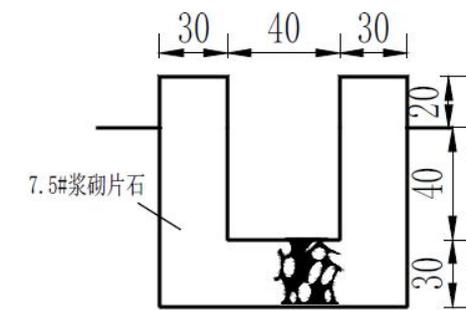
浆砌石排水沟典型断面图 (单位: cm)
